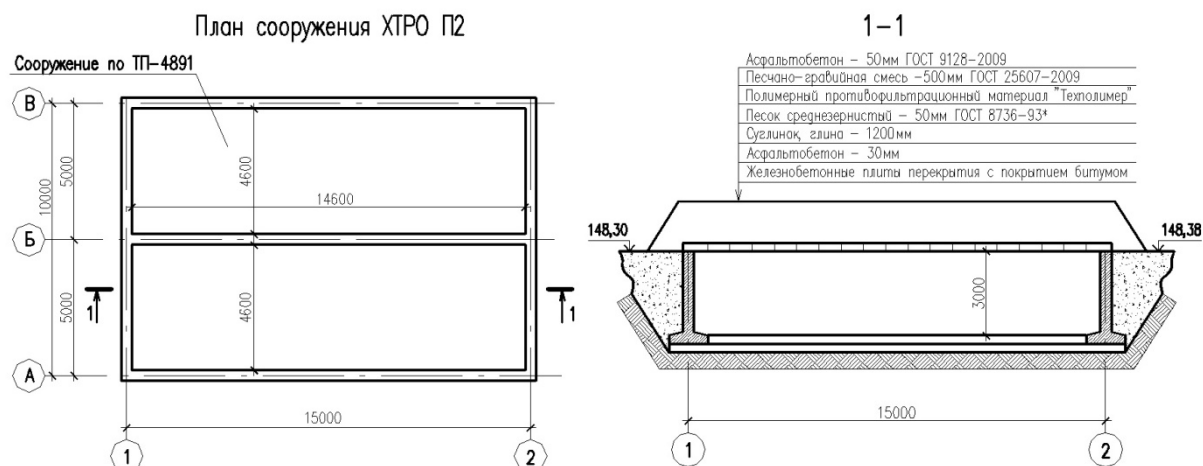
Схематичный план, разрез ХТРО П2
